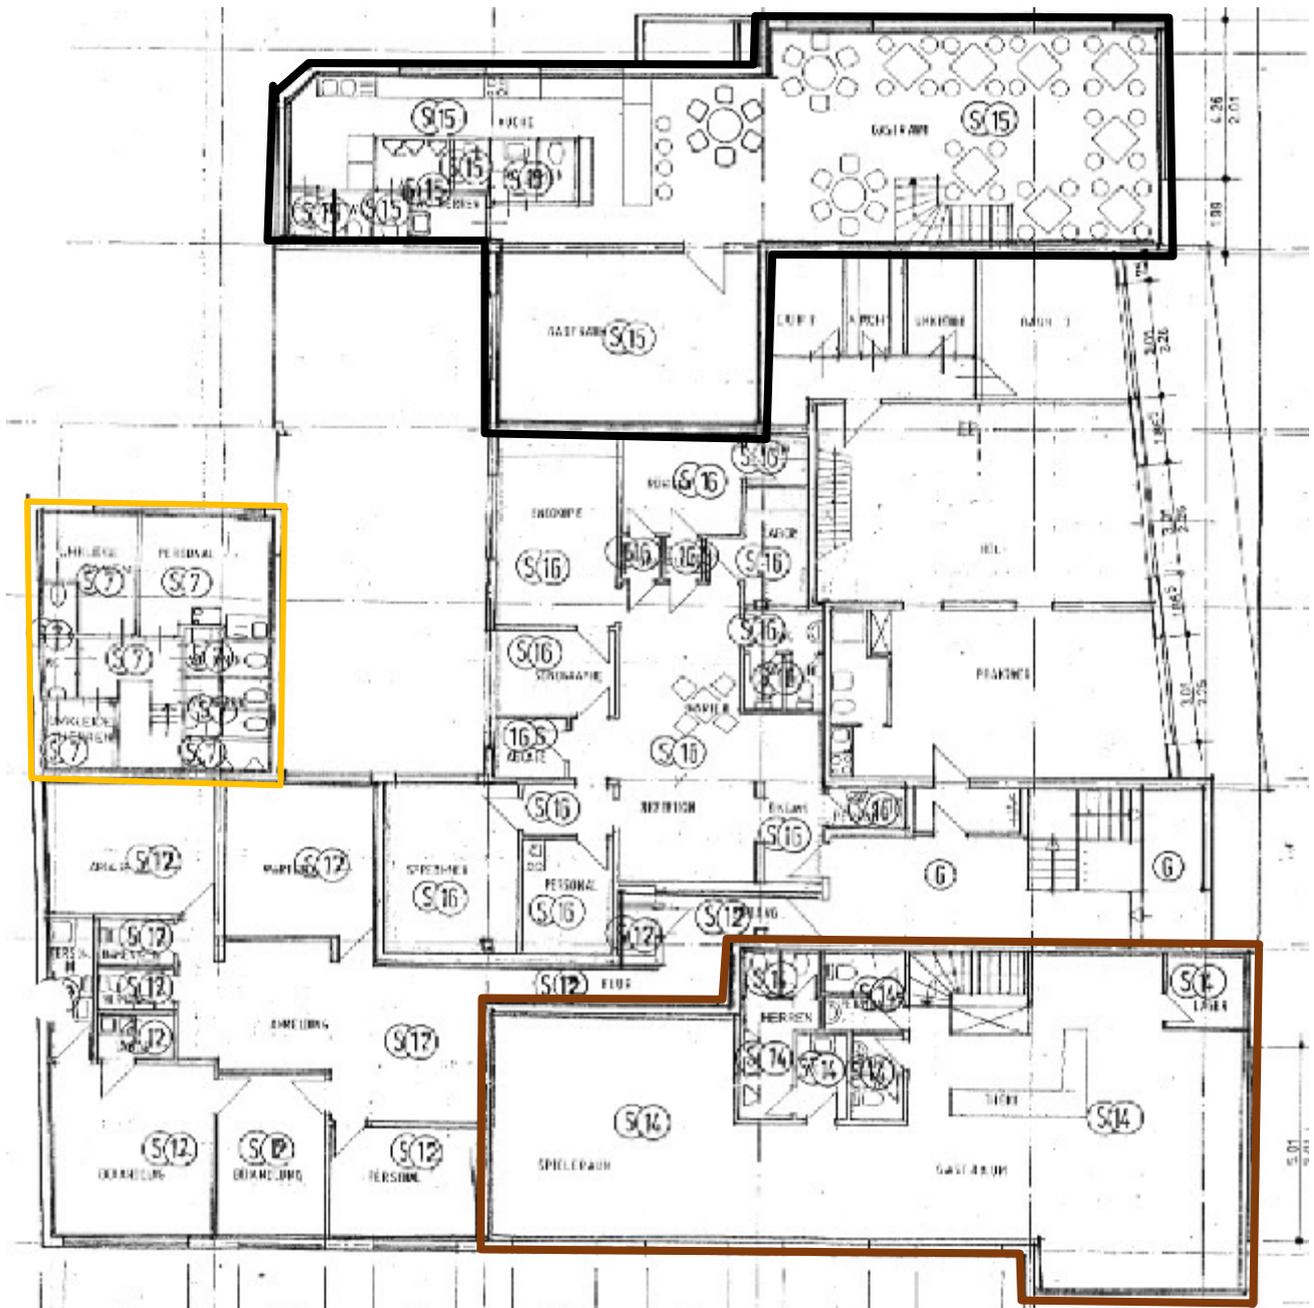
Grundrissplan Obergeschoss (ohne Maßstab); Detail: Gewerbeeinheiten S 7 (orange), S 14 (dunkelbraun) und S 15 (schwarz); Quelle: Objektunterlagen der Hausverwaltung; Baugenehmigungspläne; Farbeintragungen durch den SV
